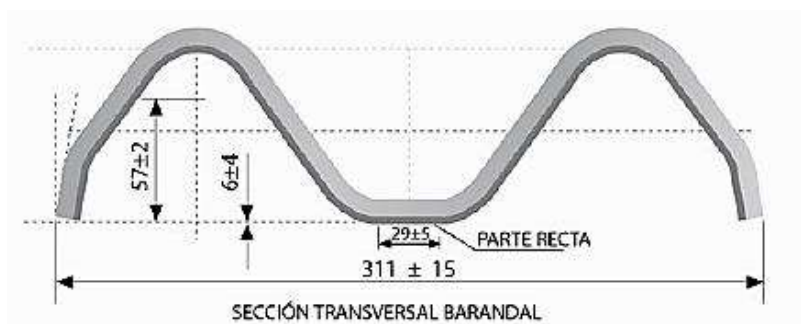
Dimensiones y configuración de la baranda metálica.
